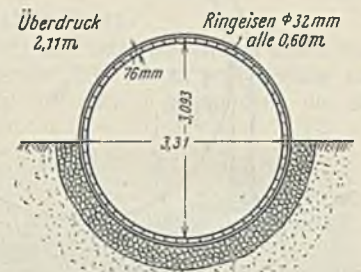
Holzrohr auf durchlaufendem Schotterbett mit schwach elliptischem Querschnitt.
